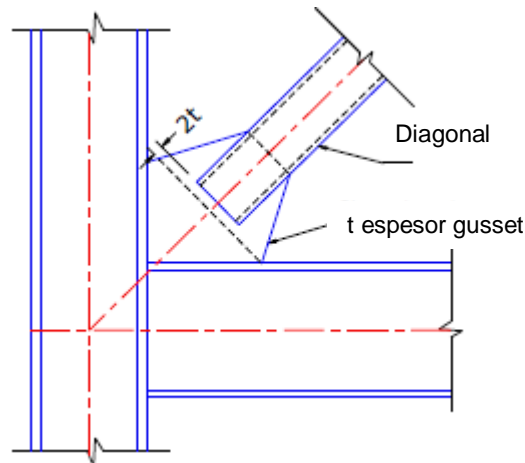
Detalle para la conexión de la diagonal tradicional con el gusset [Adaptado AISC341-10]
